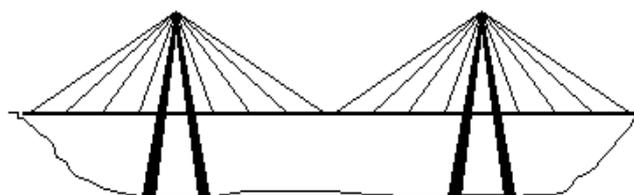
Puente sobre el río Maracaibo, Venezuela, 1962
